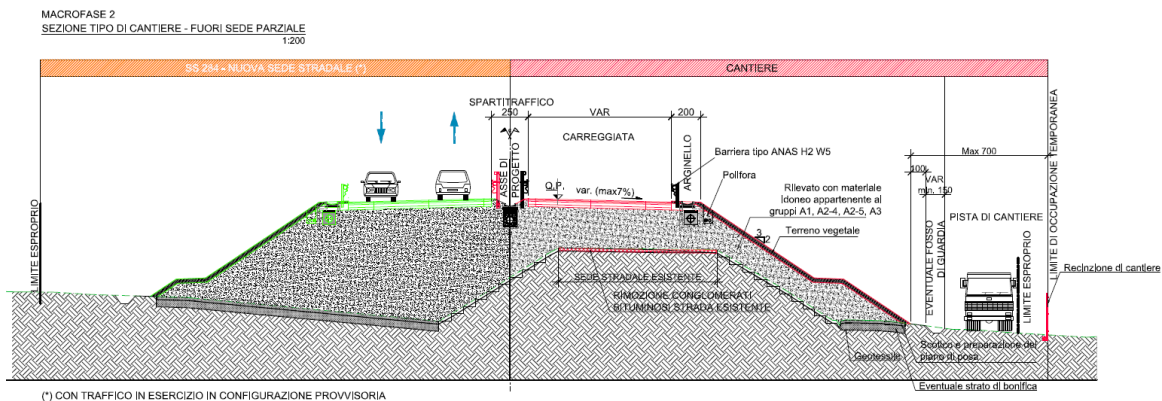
Intervento Fuori Sede Parziale (F.S.P.) — Sezione trasversale tipologica di cantierizzazione
